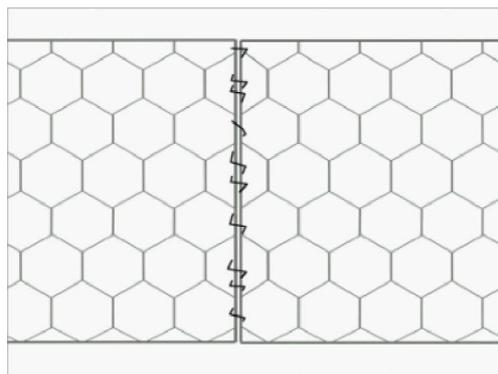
Коробчатое ГСИ- вид раскрытый
